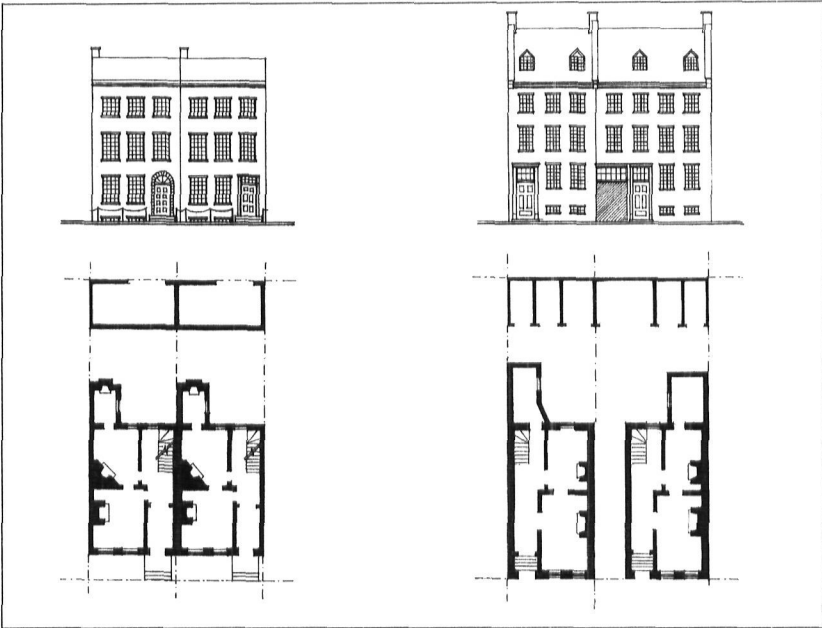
Maisons situées au 1-3, rue du Parloir, construites pour les ursulines de Québec d'après les plans de Thomas Baillaigé (photo Paul Laliberté).
